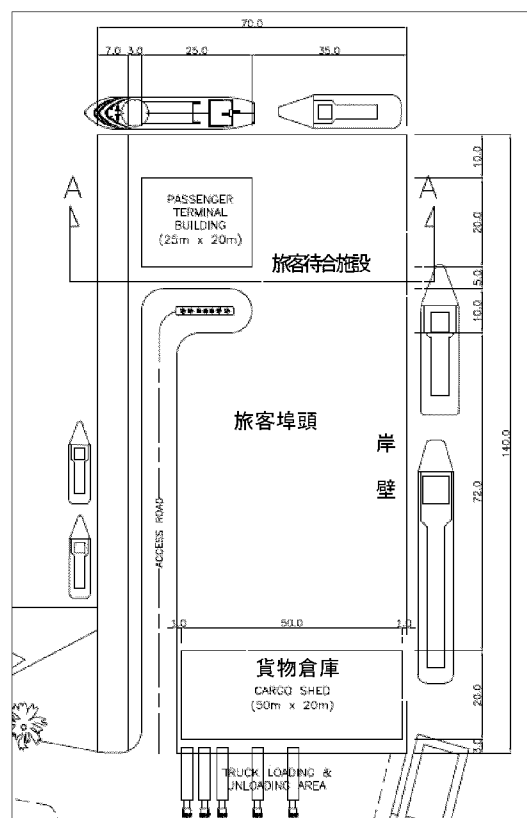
旅客埠頭の施設配置図 (要請書)
